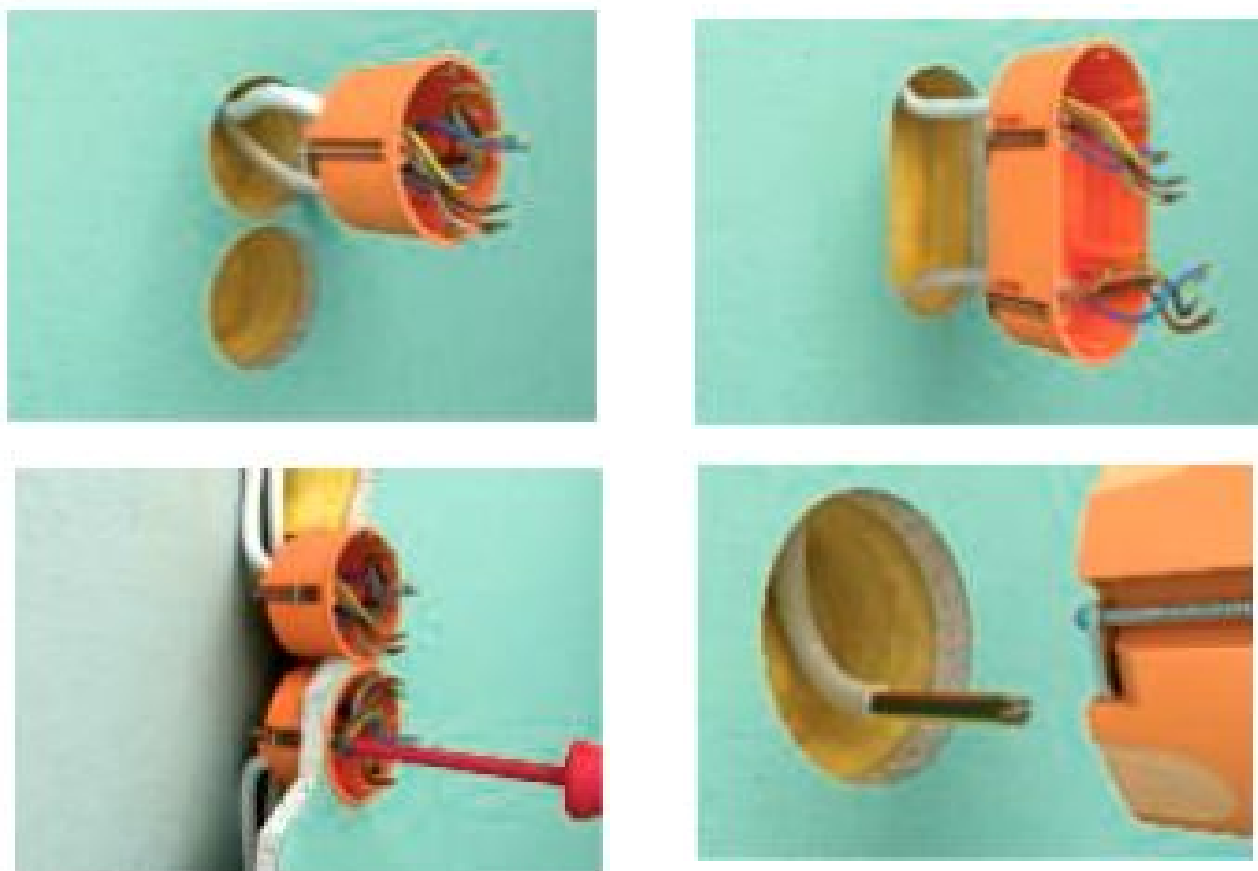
Фрагменты электропроводки в гипсокартонных перегородках
